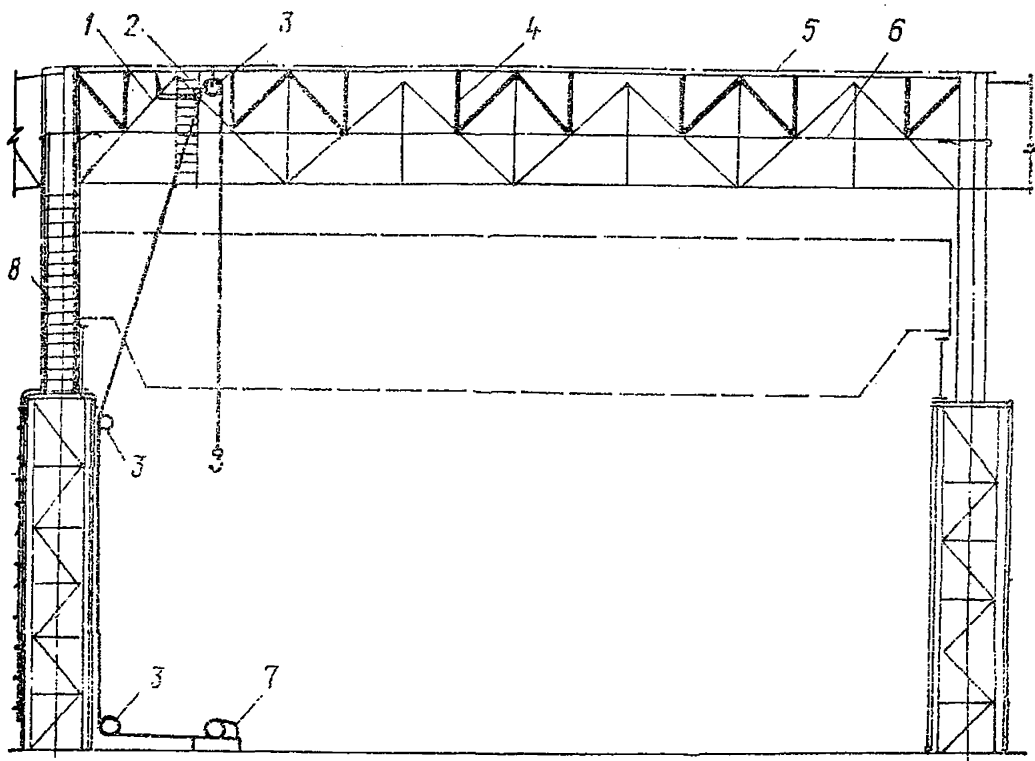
Схема усиления ферм дополнительными ненапрягаемыми элементами:
